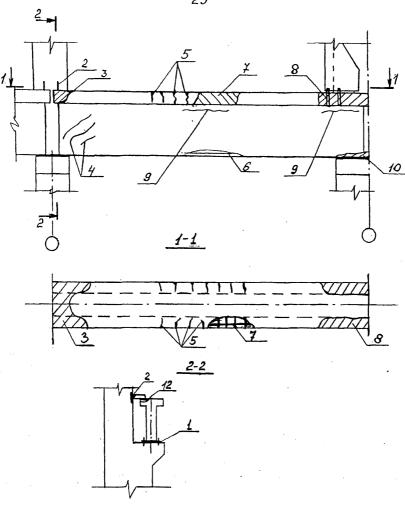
Характерные дефекты железобетонных подкрановых балок 1 - непроектное крепление балки к колонне, повреждение крепления; 2 - обрыв элемента крепления балки к надкрановой части колонны; 3 - разрушение бетона полки в опорной зоне; 4 - косые трещины у опоры; 5 - силовые вертикальные трещины в свесах полок; 6 - оголение арматуры от ее коррозии; 7 - местное разрушение свесов полок; 8 - разрушение свесов полок в местах установки упоров; 9 - горизонтальные трещины; 10 - разрушение бетона в опорной зоне; 11 - нарушение анкеровки закладной детали
